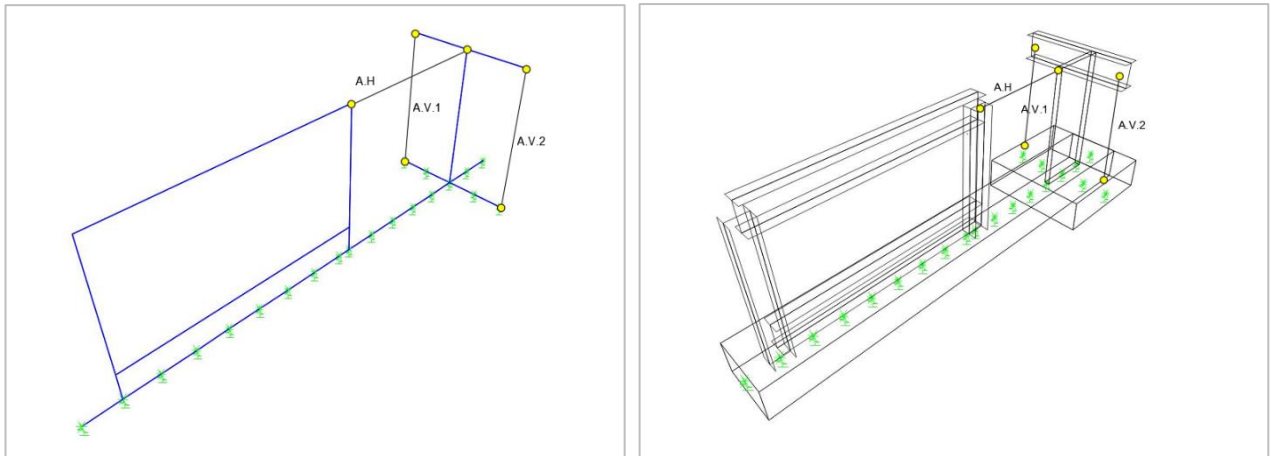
Sistema con viga de carga perpendicular al eje del espécimen: A) Vista normal elementos; B) Vista extruida elementos
